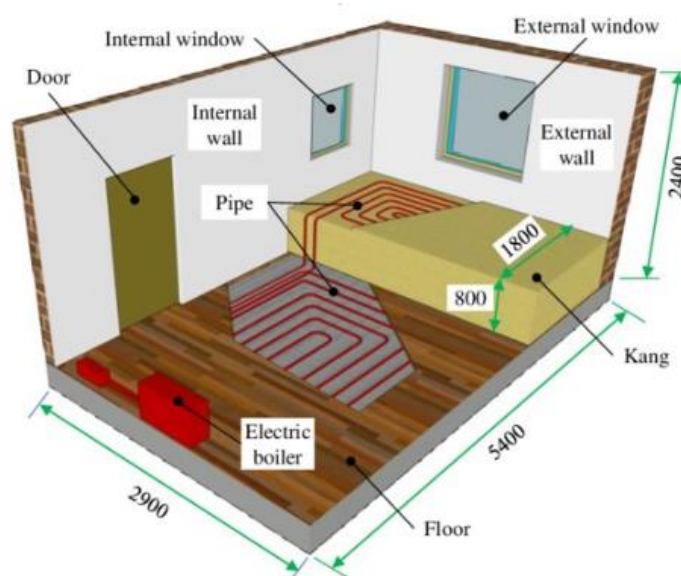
Espace de vie muni d'un plancher chauffant hydraulique et d'un Kang chauffant
